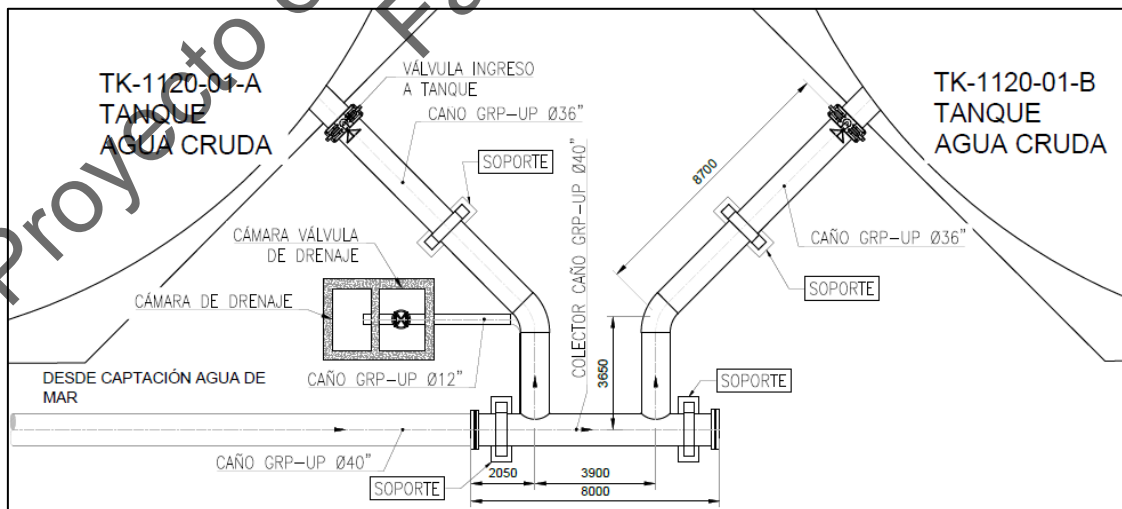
Vista en planta del colector de ingreso a la Planta de Tratamiento de Agua.
